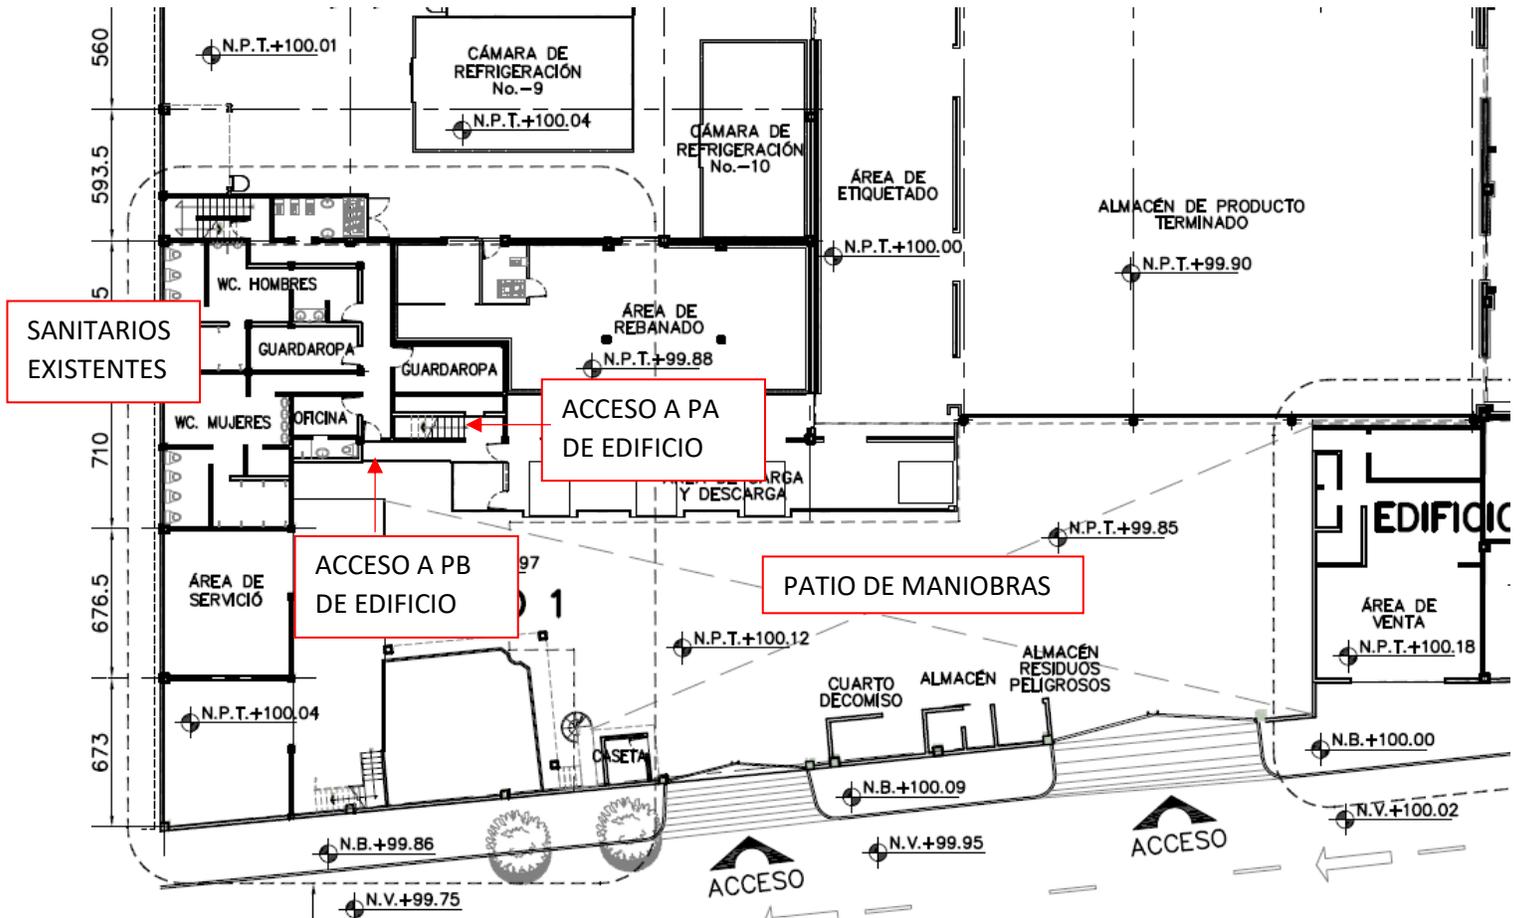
Plano de estado actual del sitio, zoom en la zona de interés.
